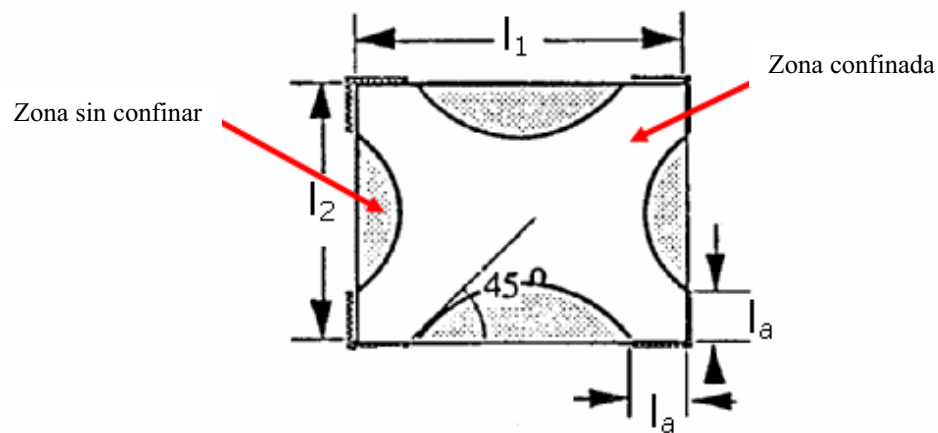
Confinamiento del hormigón en una sección reforzada (adaptado de Dritsos y Pilakoutas 1992)
